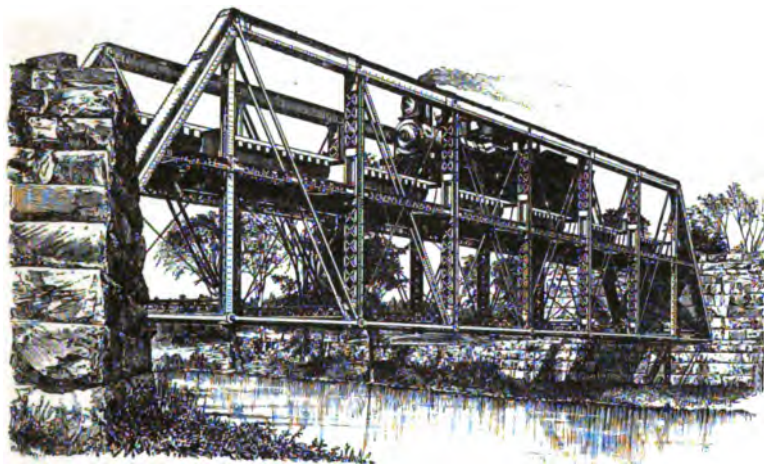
Pont de Torrington (Rail-Road Gazette).
